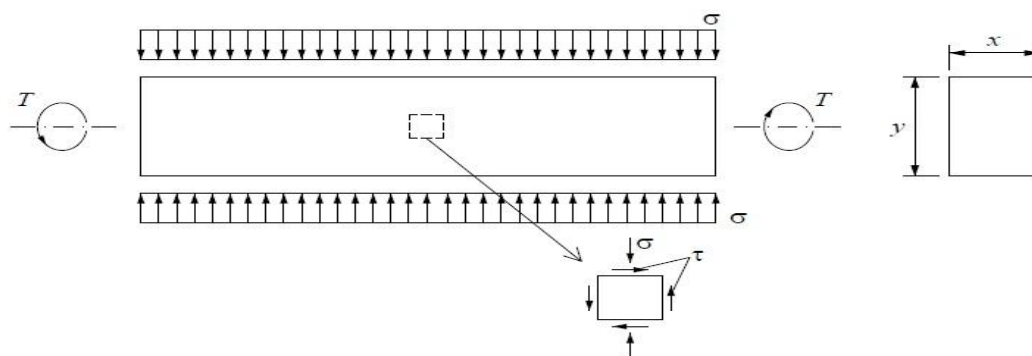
Estado de tensão numa viga sujeita à torção e a um pré-esforço transversal [10]
